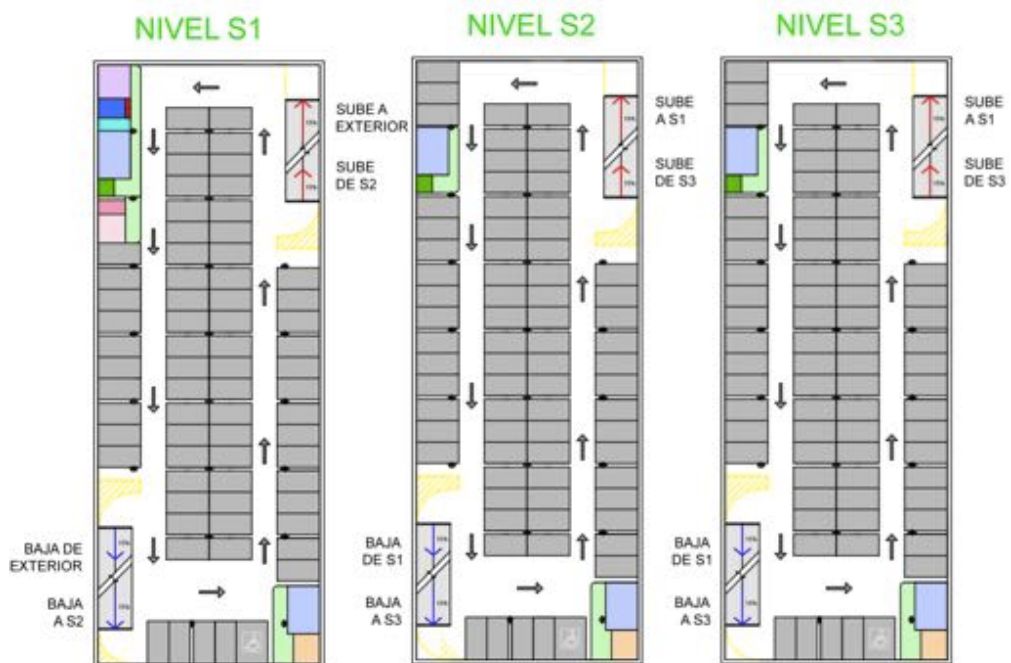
Alternativa 6 - Ubicación 3 y 3 Plantas
